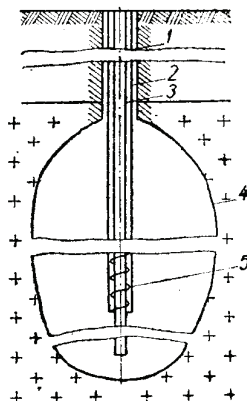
Конструктивная схема перемешивающего устройства [47]:
